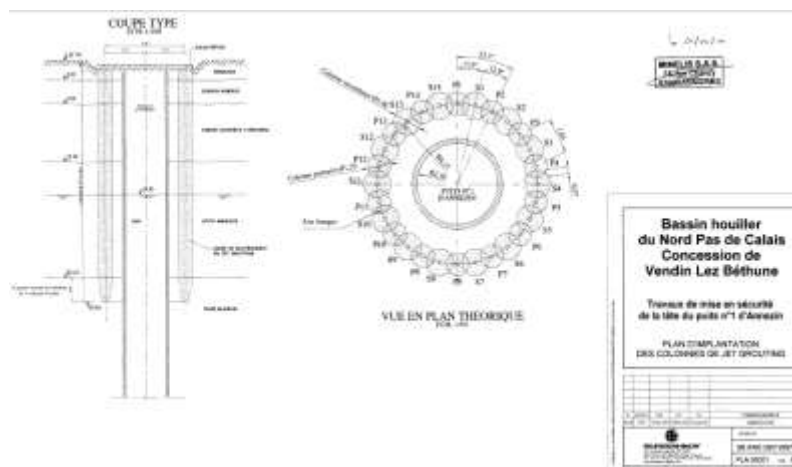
Plan de réalisation des colonnes de jet-grouting
